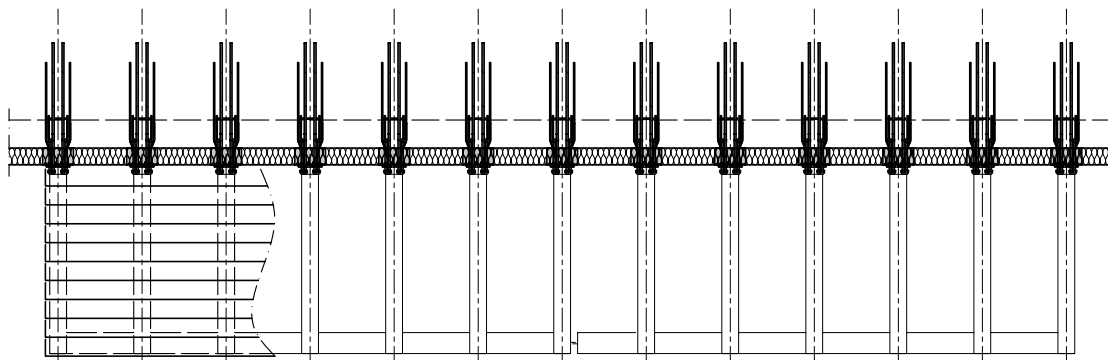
Schöck Isokorb® XT type SK : balcon en porte-à-faux
